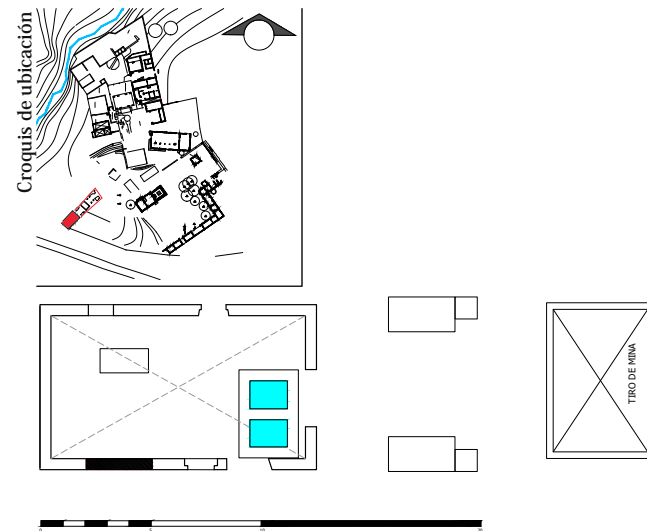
Planta arquitectónica del estado actual de la casa de extracción y el tiro de mina
